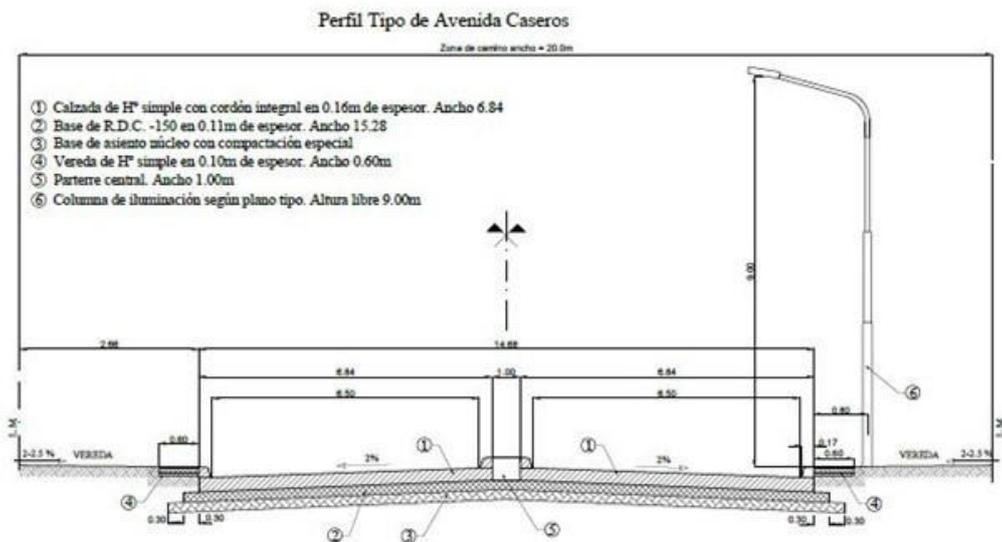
Perfil de Obra tipo Av. Caseros -Fuente: Informe de Ingeniería.
